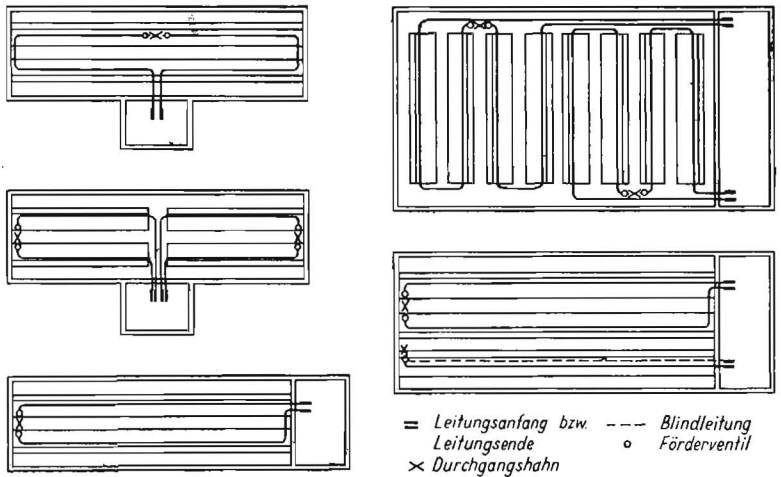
Einbaumöglichkeiten für Rohrmelkanlagen
